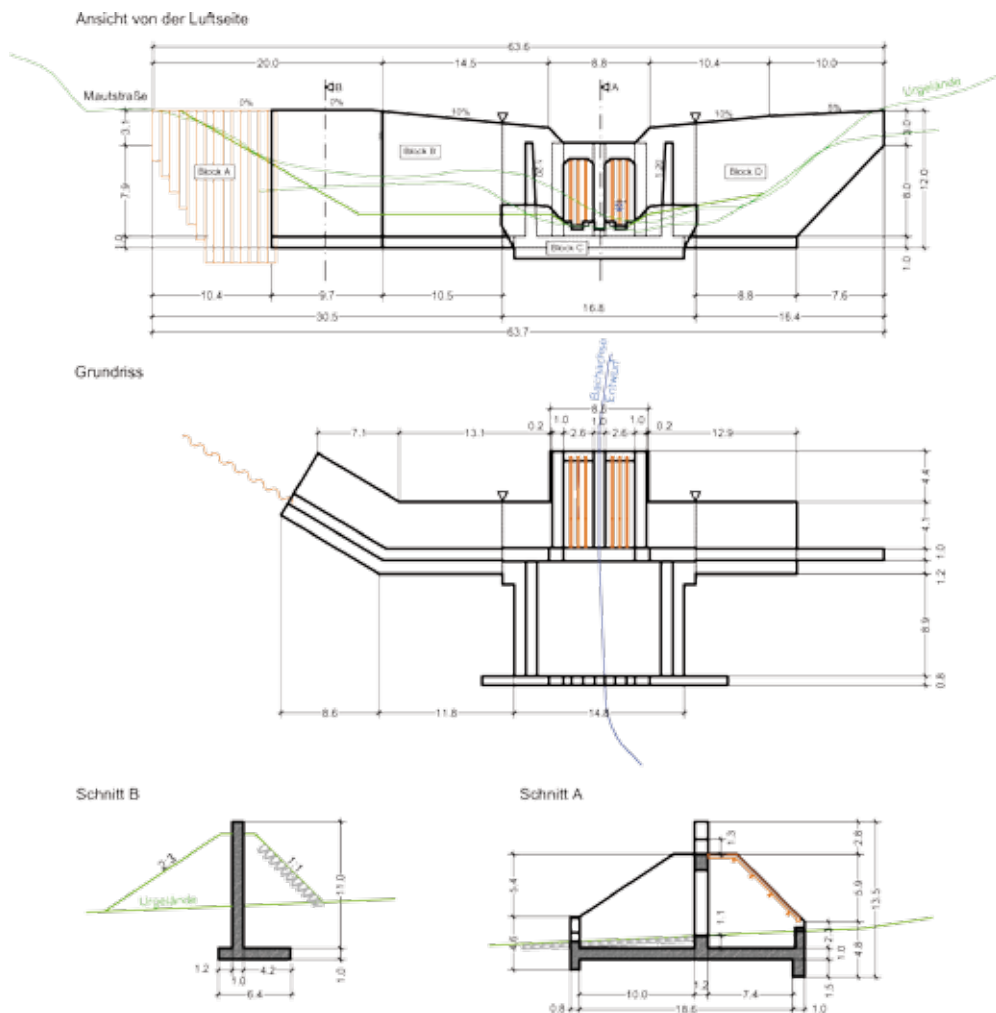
Grundriss, Ansicht, Schnitt der Dosiersperre.
